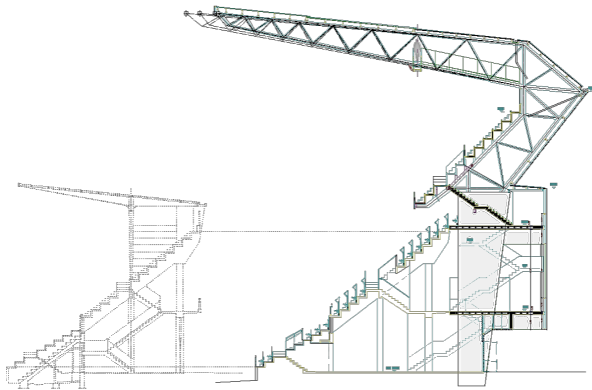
Nueva estructura de grada norte 2020 (derecha) junto a estructura anterior a 2020 (izquierda)
